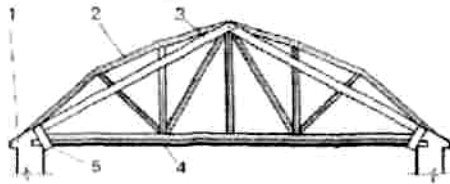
Схема підсилення дерев'яної ферми перетворенням на тришарнірну арку: 1 - існуючі конструкції; 2 - ферма, що підсилюється; 3 - елемент арки підсилення; 4 - металева затяжка; 5 - накладка
